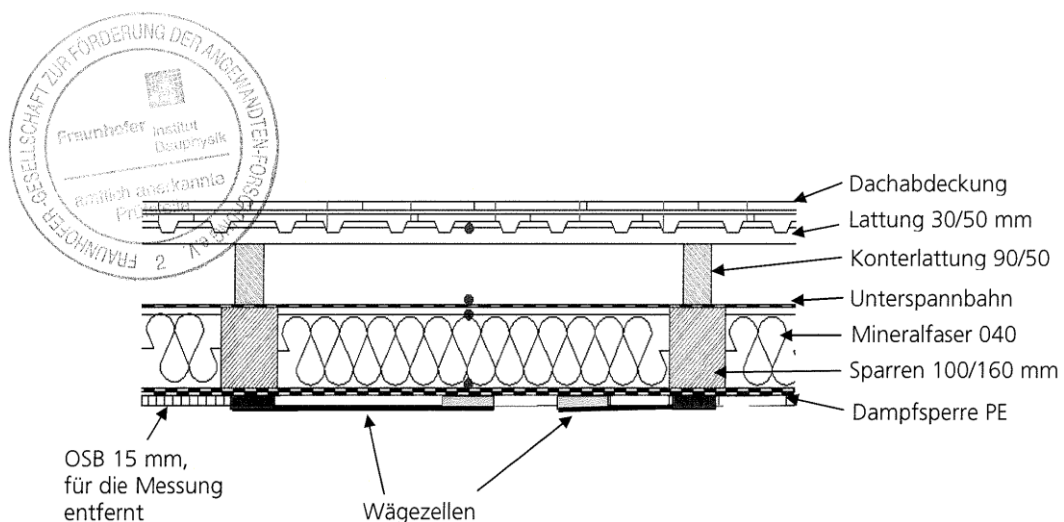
Aufbau des Versuchsdachs zur Messung der auftretenden Lasten an der Luftdichtheitsschicht. Testhaus – Sparrendach mit Dampfbremsschicht und Klebdichtmasse, Wärmedämmung und Dacheindeckung [7].
